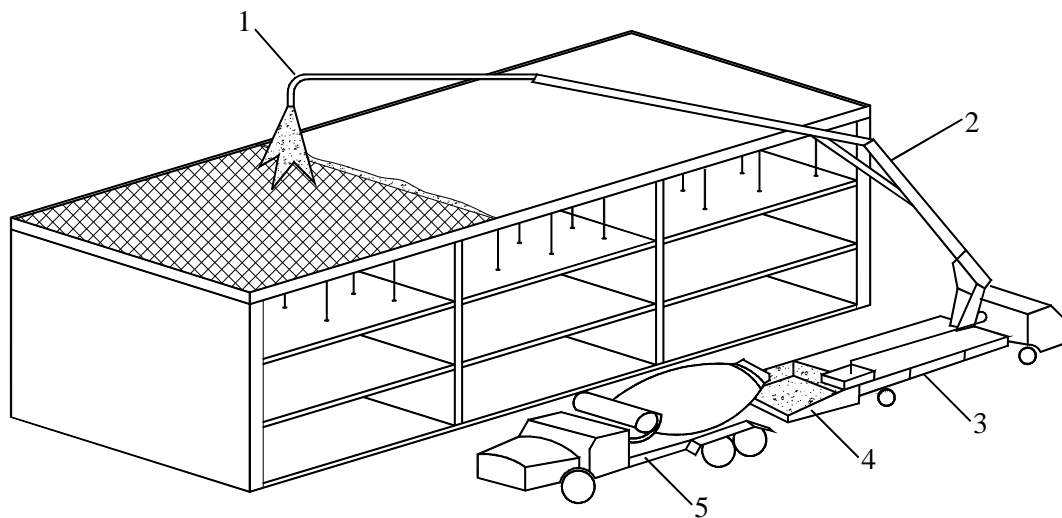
Схема бетонування за допомогою автобетононасосу з розподільчою стрілкою:
